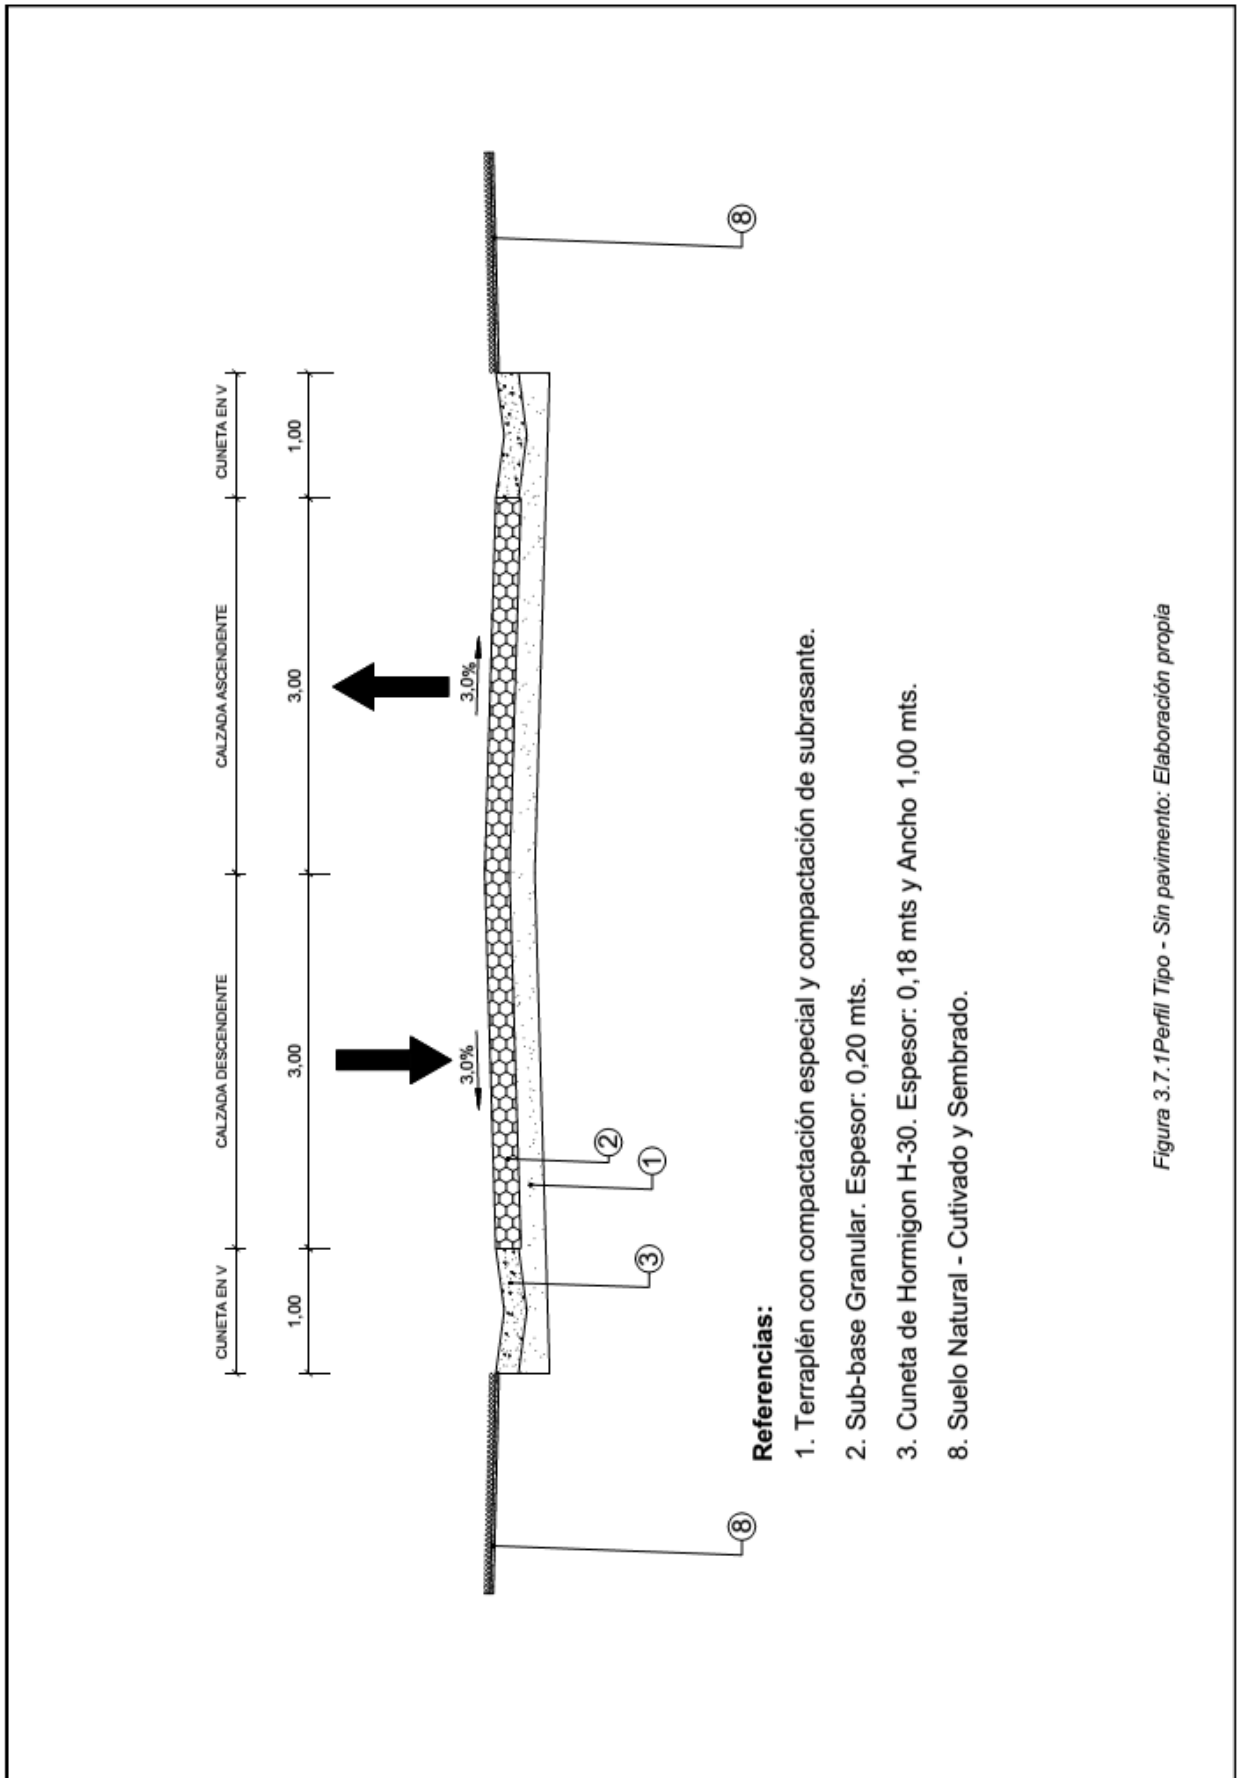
Perfil Tipo - Sin pavimento: Elaboración propia
